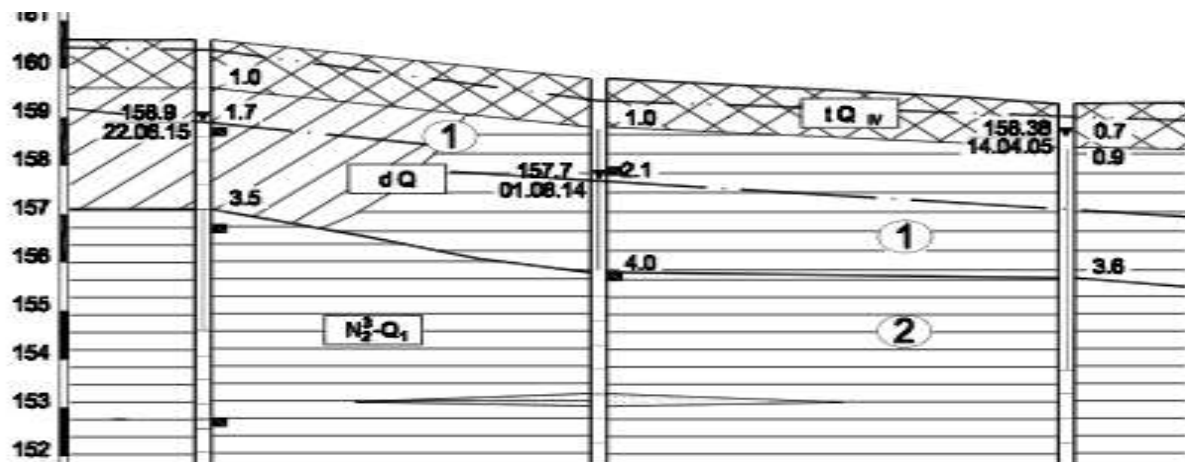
Геологический разрез площадки №3 (г. Уфа)
